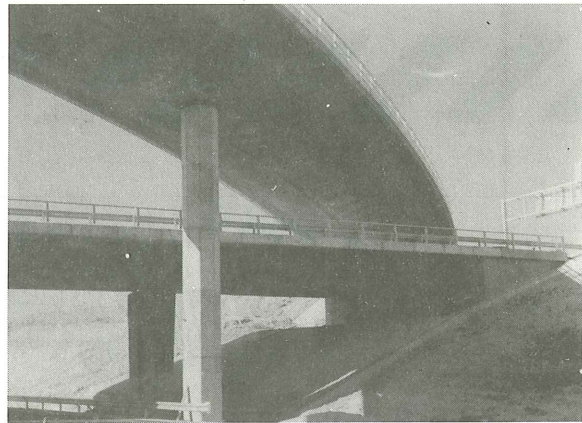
Aspecto de los puentes 2 y 3. Estribos lado Madrid.
